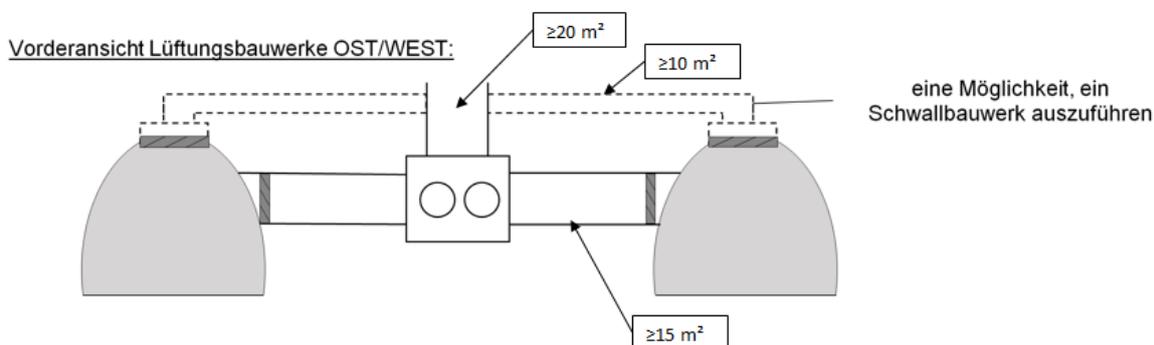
Vorderansicht Lüftungsbauwerk OST/WEST, zwei eingleisige Tunnelröhren
